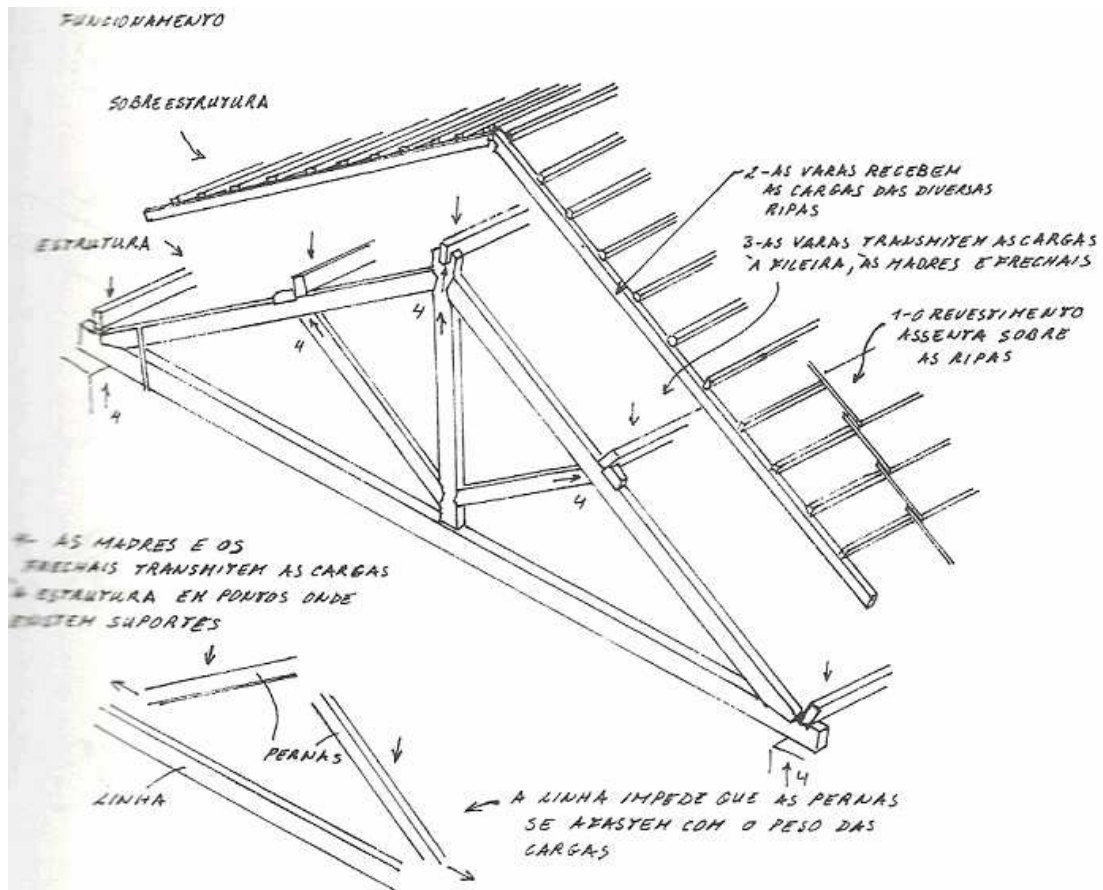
Esquema de funcionamento e descarregamento dos vários elementos da estrutura de coberturas tradicionais (Mascarenhas, J., 2006)
